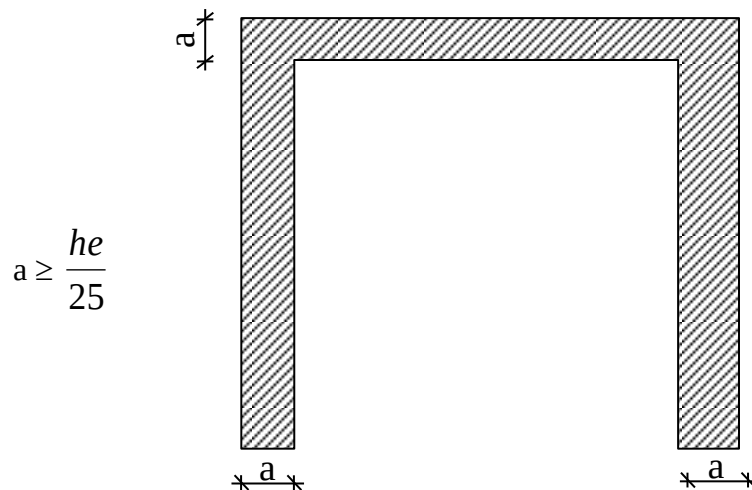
Vue en plan de voile de la cage d'ascenseur.
